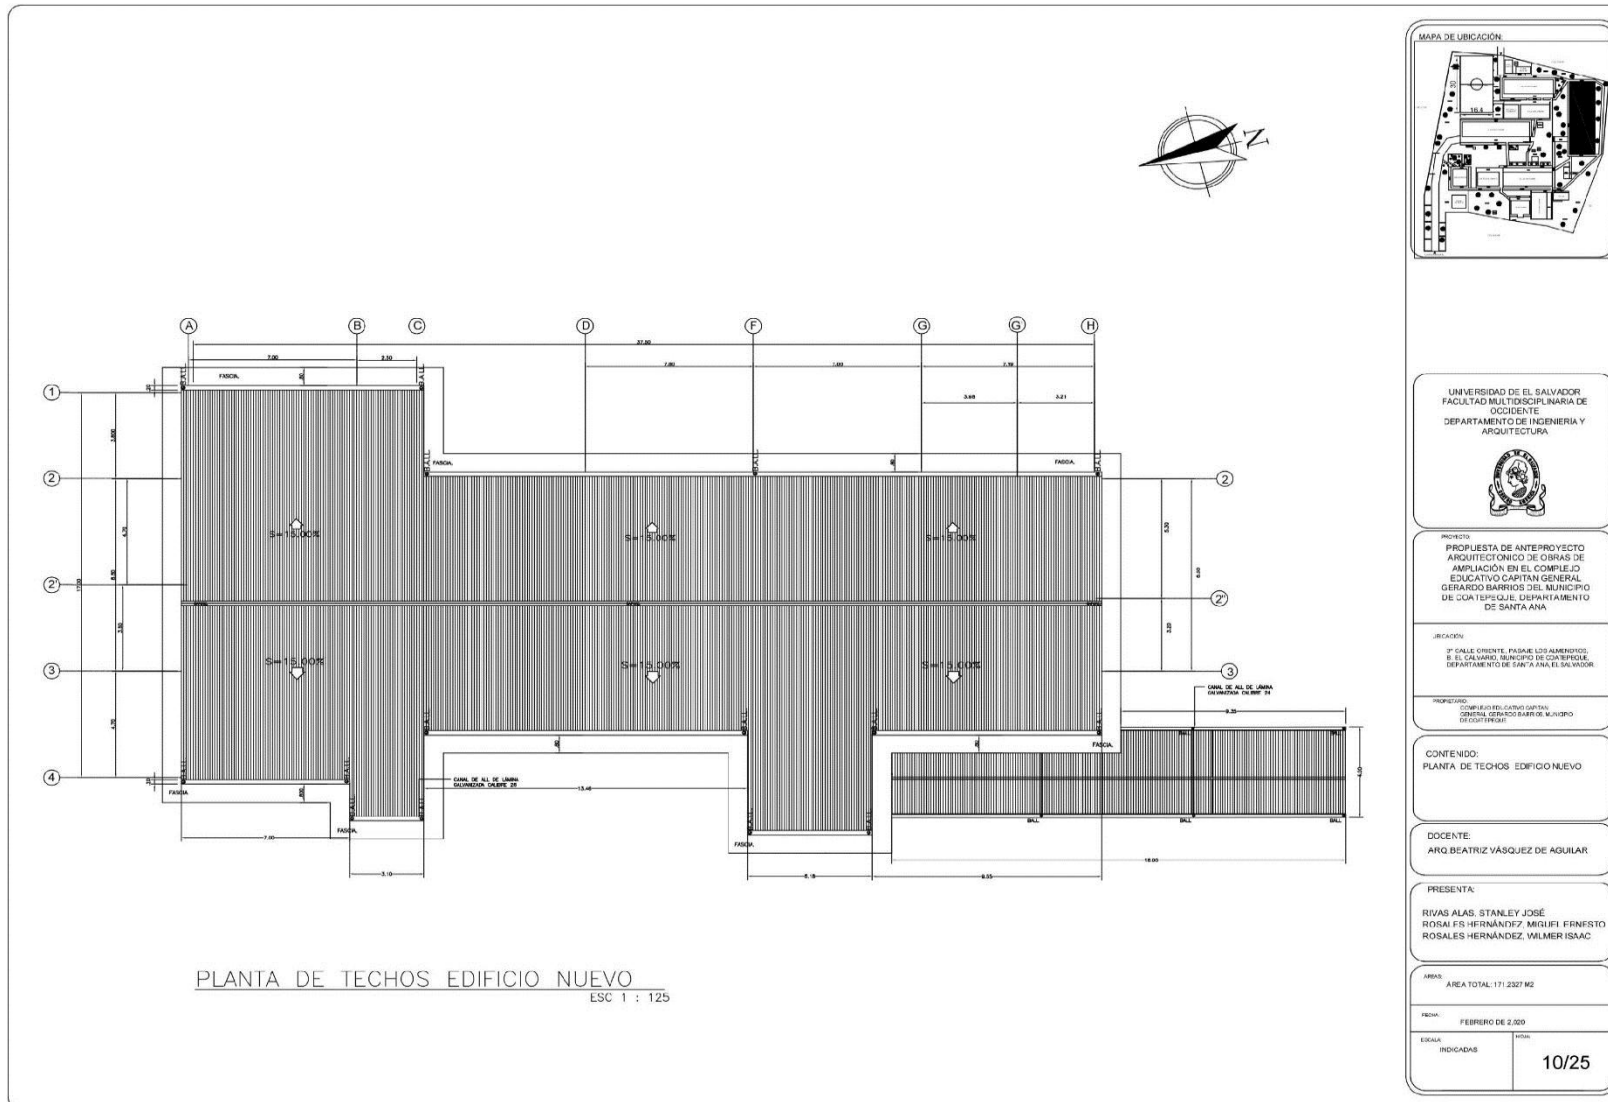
PLANTA DE TECHO, EDIFICIO NUEVO "PROPUESTA DE ANTEPROYECTO".
